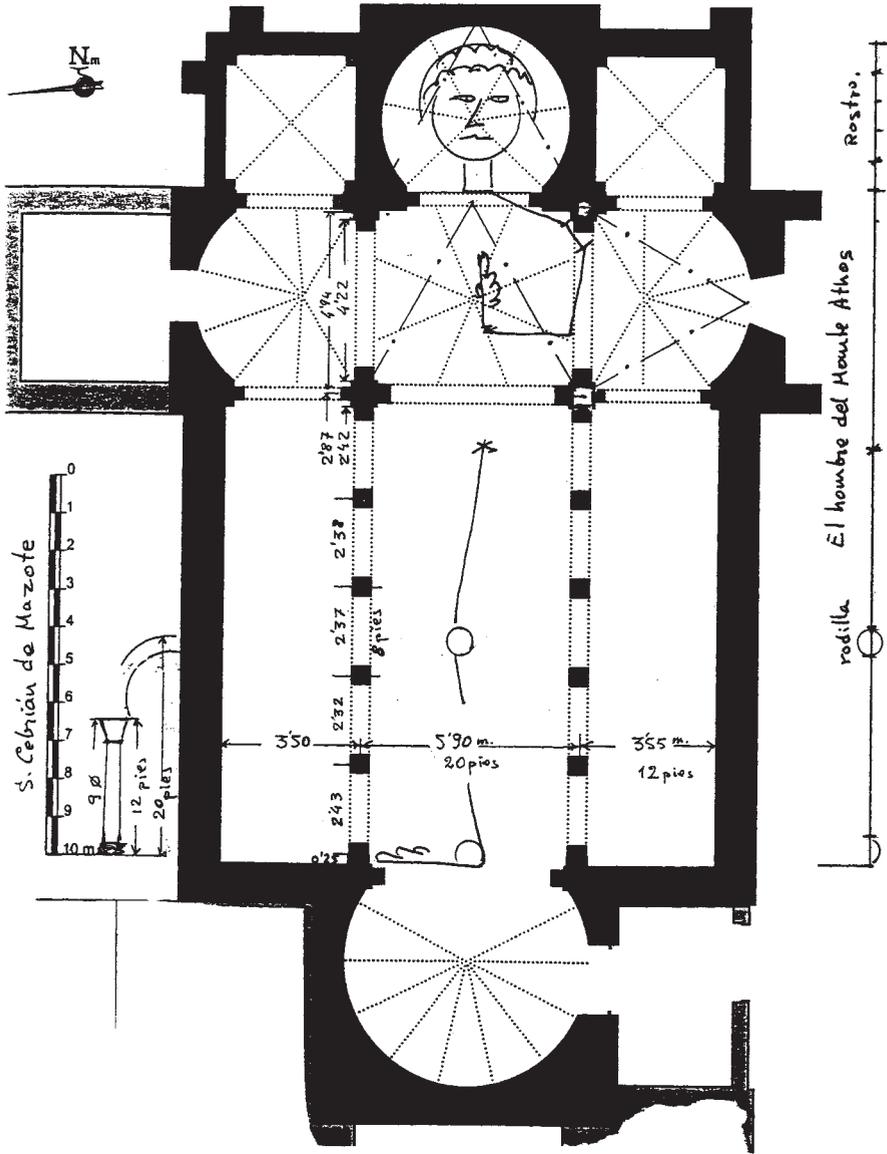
San Cebrián de Mazote. Medidas sobre la planta de R. Puenite.
